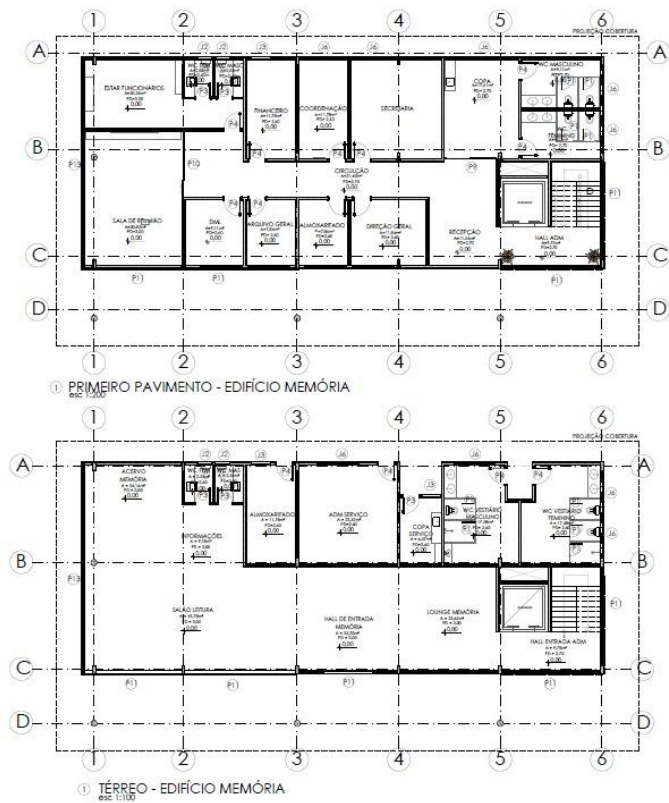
Planta Baixa – Térreo e 1º Pav. Ed. Memória
